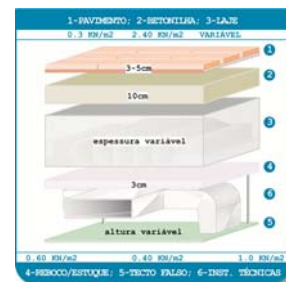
Laje + Tecto Falso Presdouro 10cm Betonilha Normal
